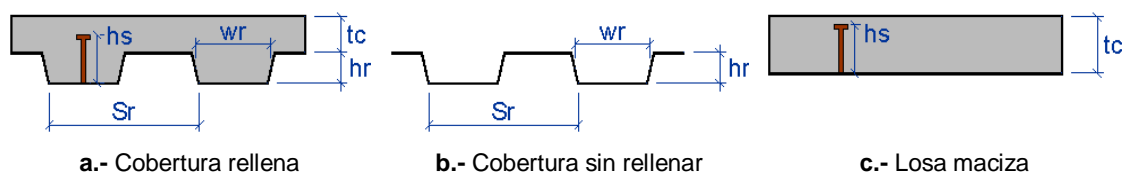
Tipos de secciones de los elementos tipo cobertura.
